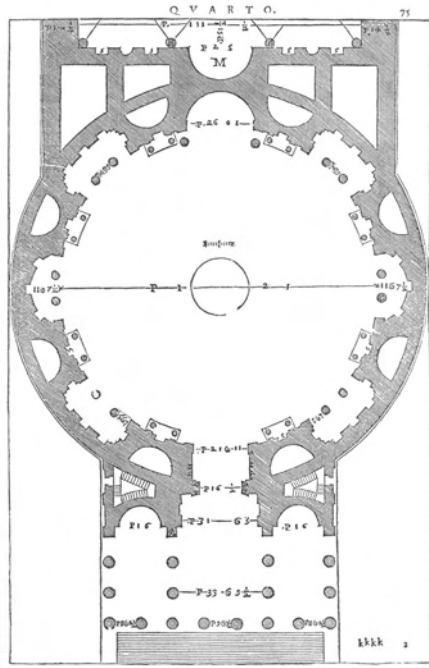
Planta baixa Pantheon - segundo Palladio - Fonte: Palladio, 1570
